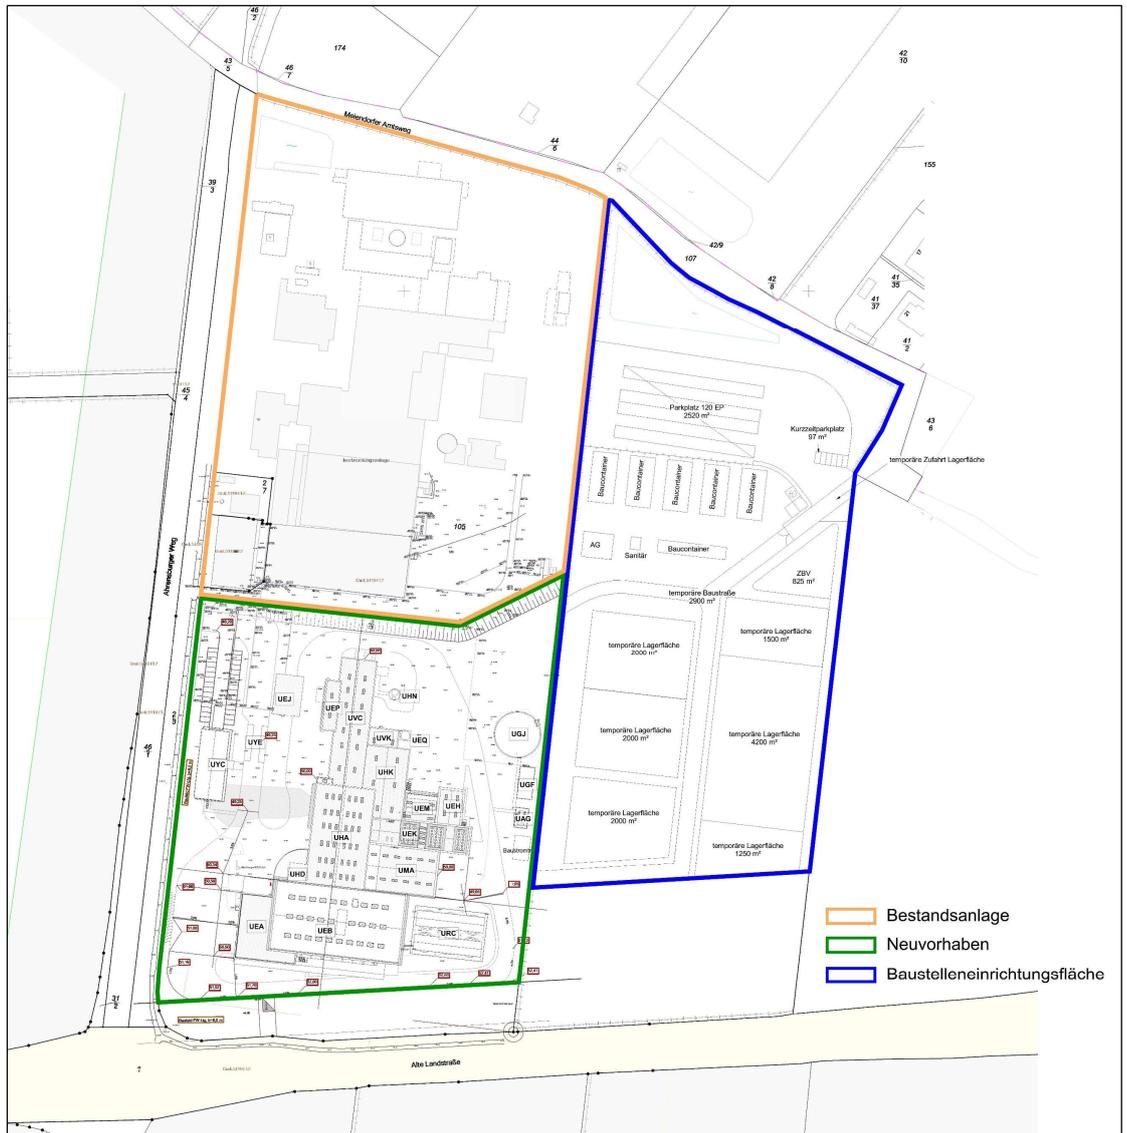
Gesamtlageplan (MHKW, KVA, Baustelleneinrichtungsflächen)
